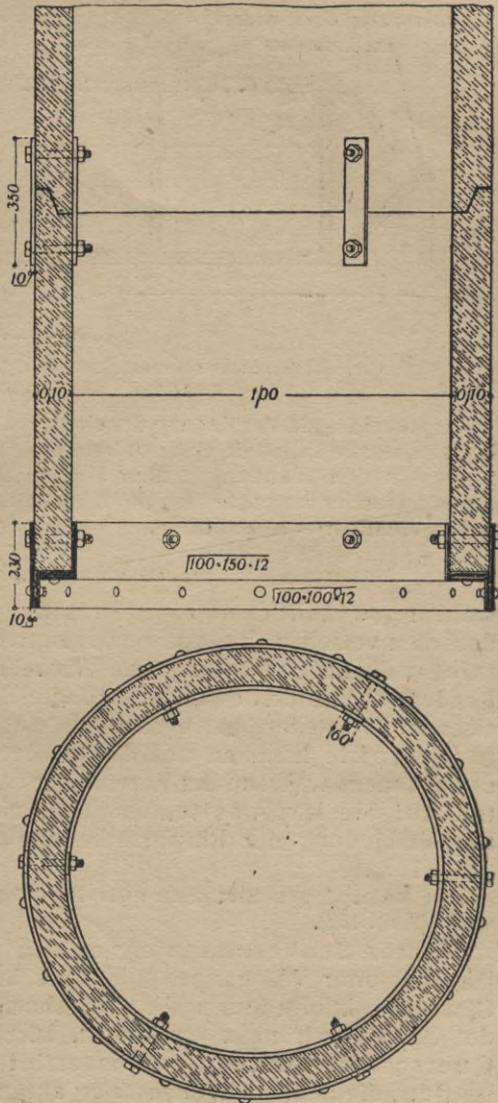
Brunnenringe aus Beton mit Bewehrung der Schneide und Sicherung des Stoßes.
